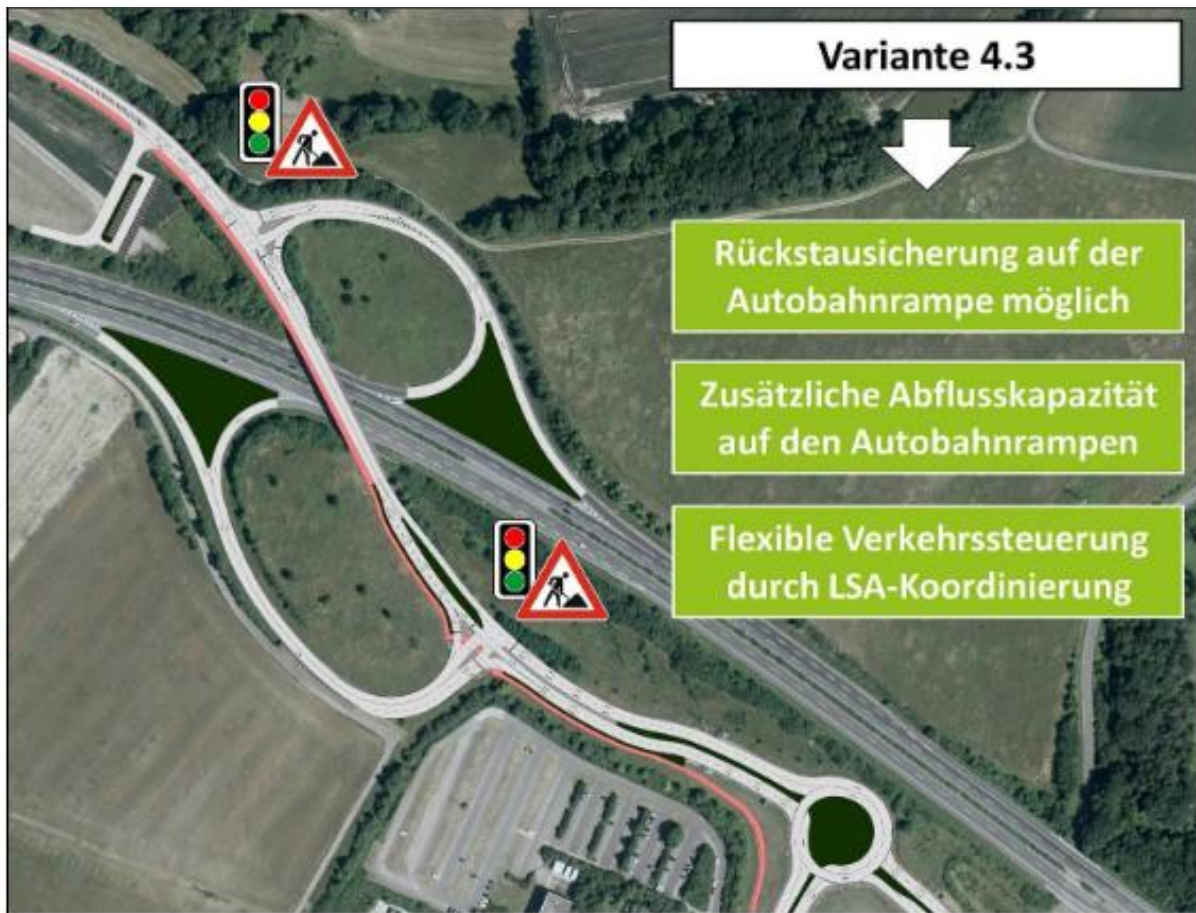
Vorzugsvariante zum Ausbau der AS Contwig – Verkehrsführung und Betriebsformen der Knotenpunkte (BBW, 2025).
